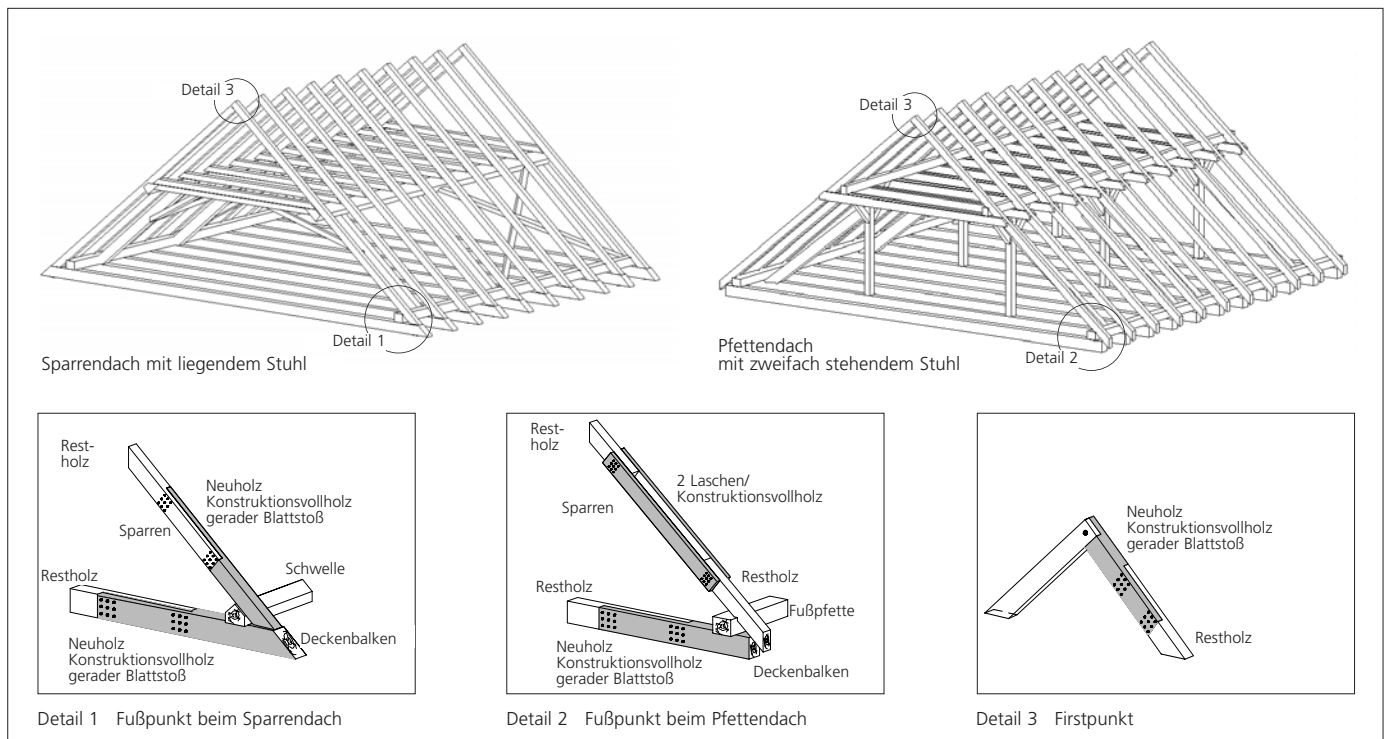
Instandsetzung von Dachkonstruktionen – Grundprinzipien
